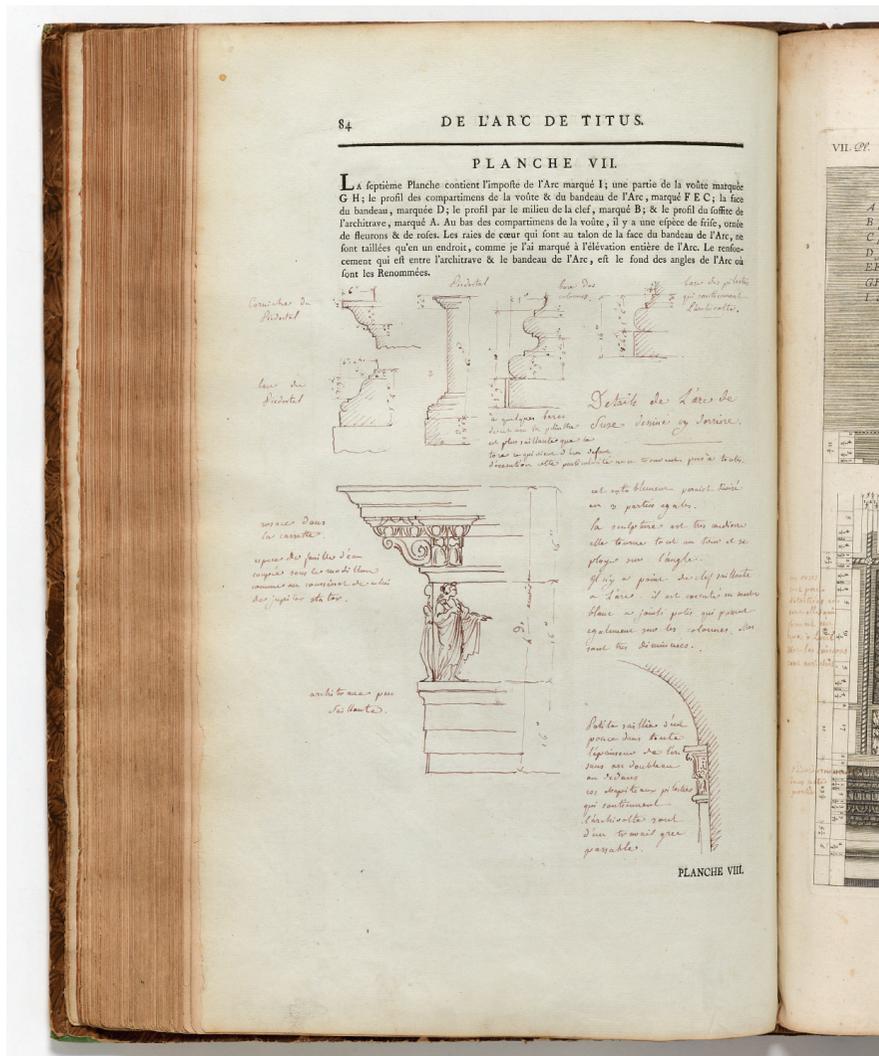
(below) Details de L'arc de Suzé dessiné cy derrière
